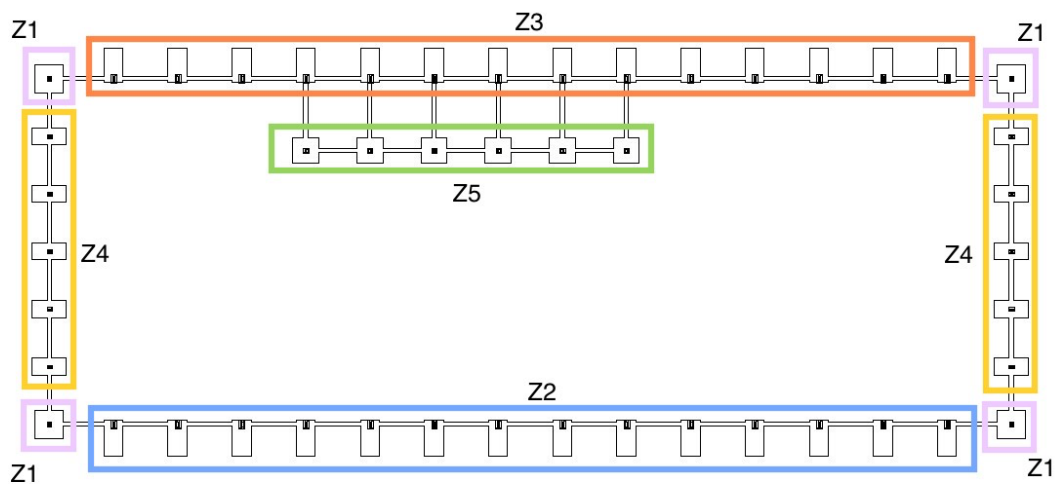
Disposición de los elementos de cimentación. CYPE Ingenieros.
